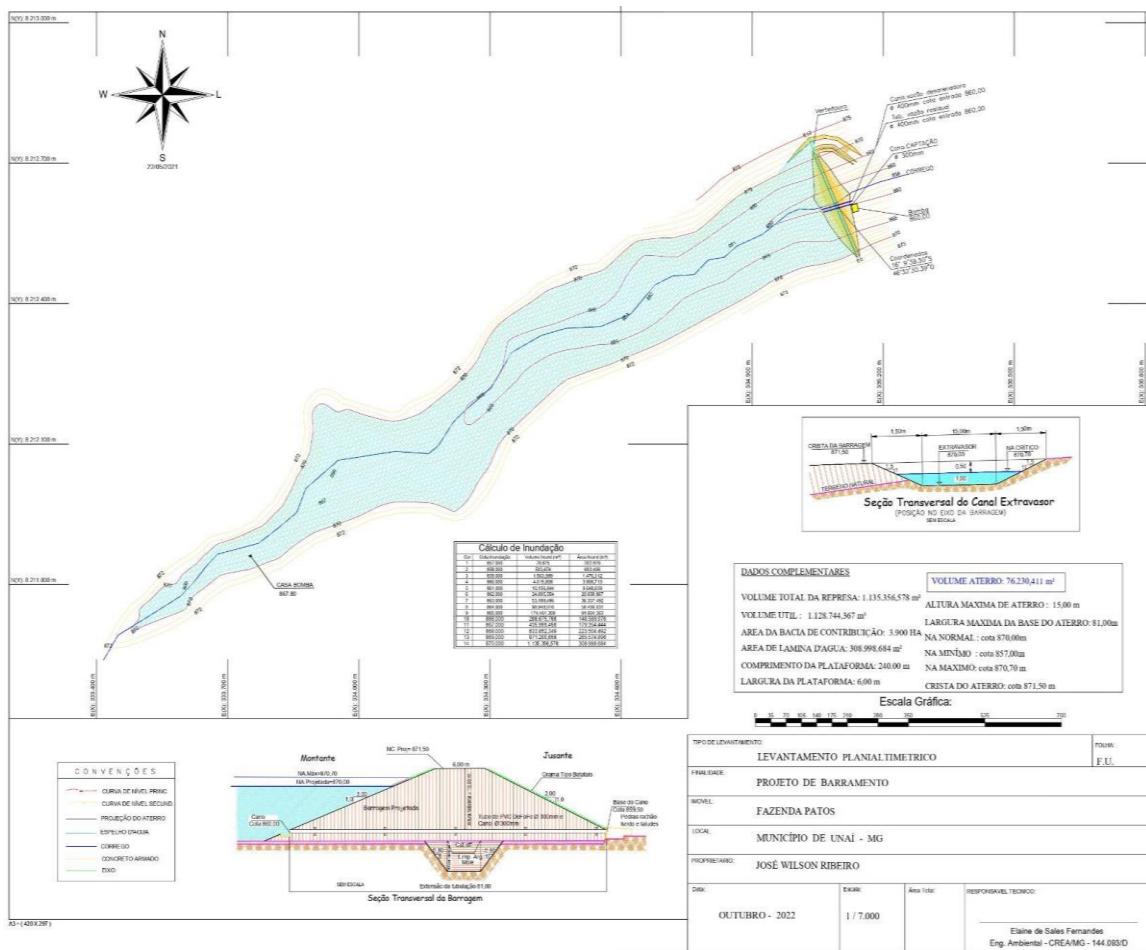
Projeto da barragem a ser construída. Fonte: Pimenta consultoria ambiental.
